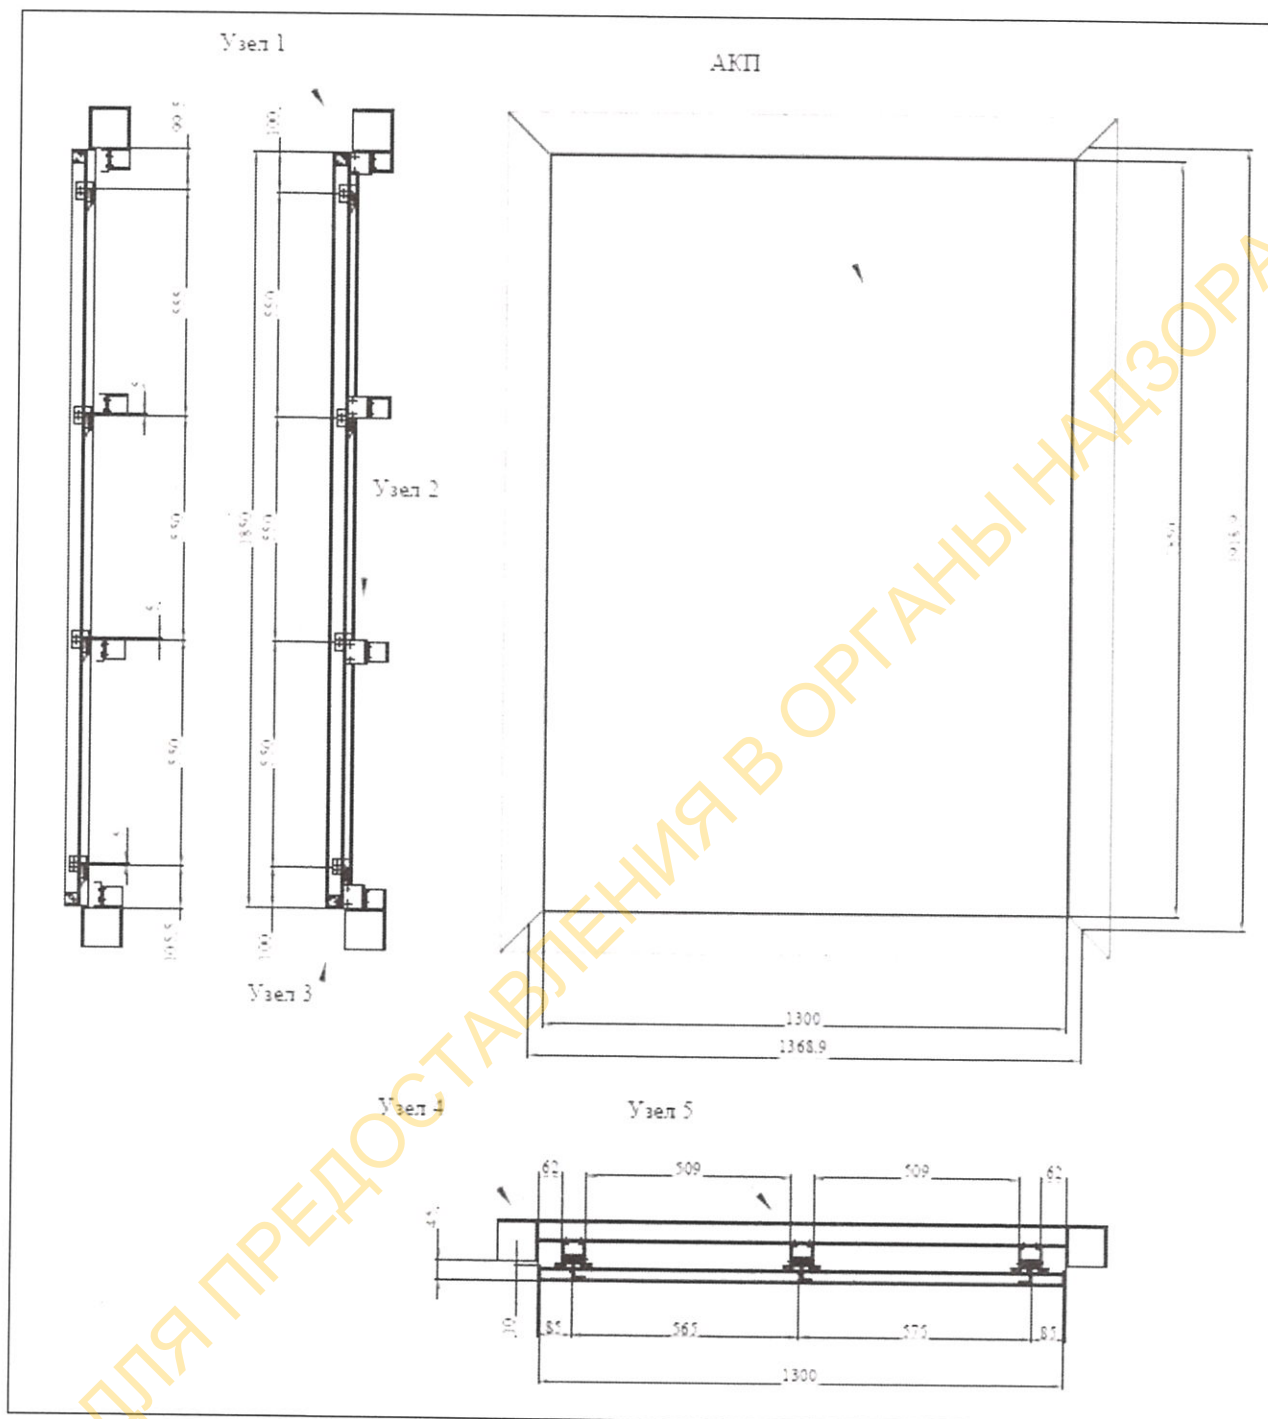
Общий вид, горизонтальный и вертикальный разрезы по испытуемому образцу 1134-24
